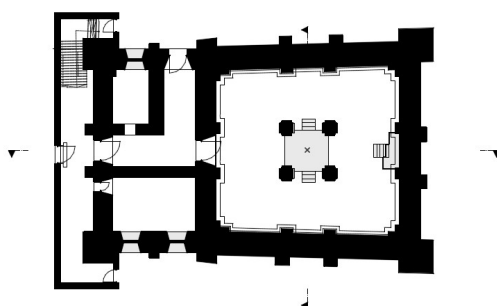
Grundriss_EG_Rekonstruktion
